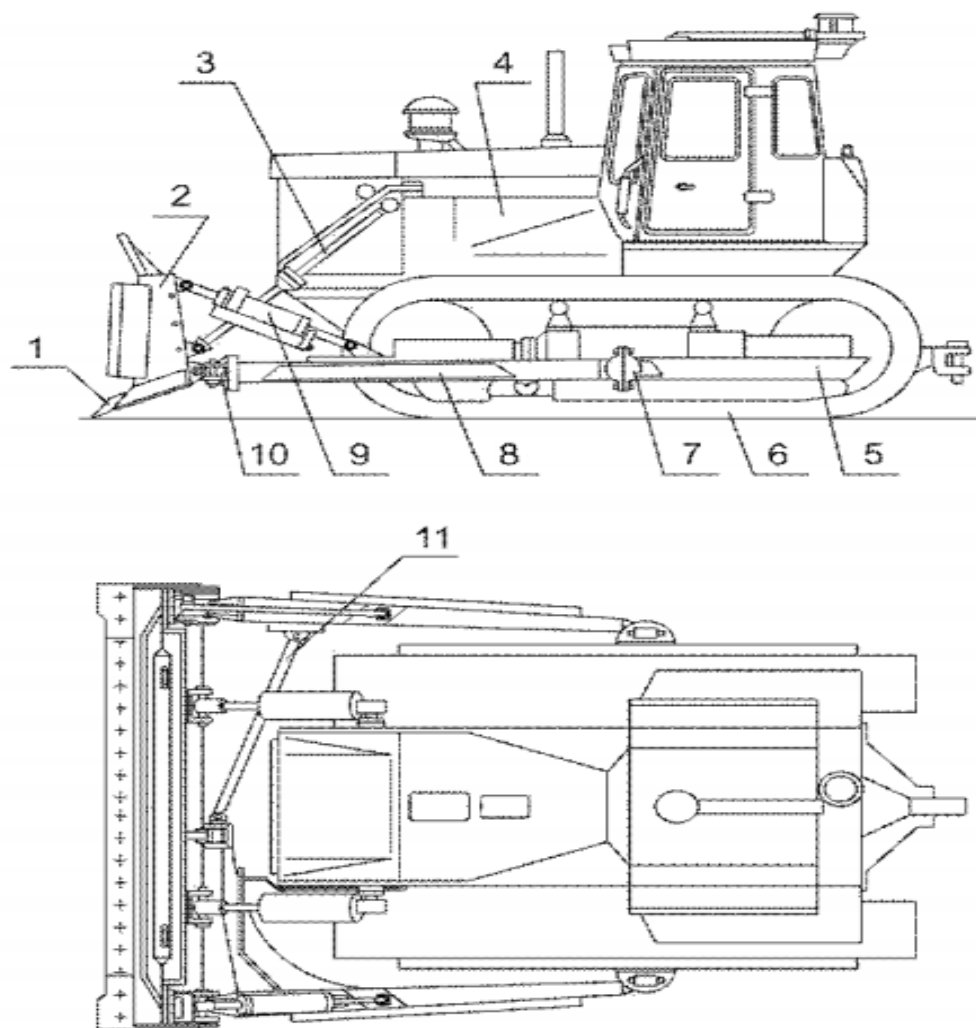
Конструктивная схема бульдозера с неврещающим щитом: 1 - нож; 2 - щит; 3 - гидроцилиндр для подъема и опускания щита; 4 - силовая установка с: коробкой передач; 5 - гусеничная тележка; 6 - гусеницы; 7 - шарнир; 8 - толкатель; 9 - гидронасос; 10 - Универсальный шарнир; 11 - Компенсаторный механизм
